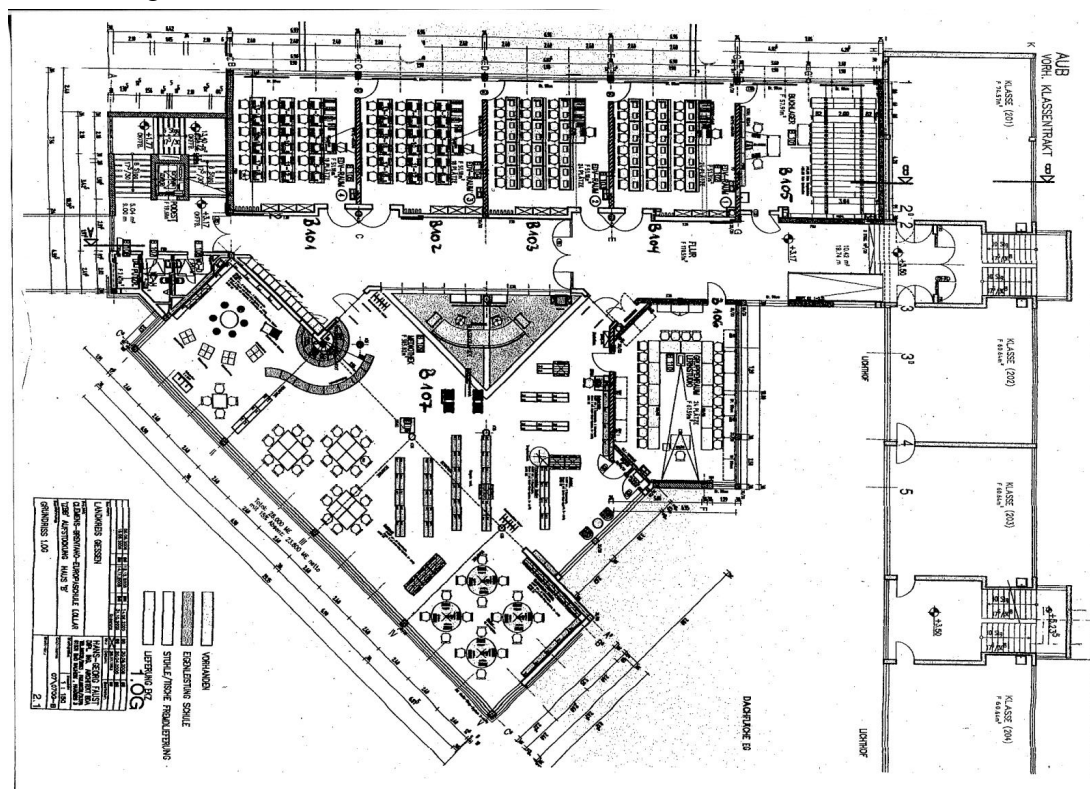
Grundriss der Stadt- und Schulmediothek²⁰⁸
